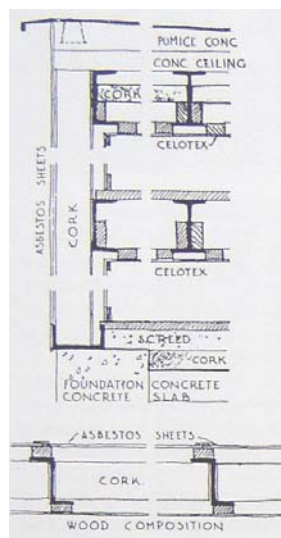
Sección de fachada de la casa de la Weissenhof, Walter Gropius. (Tectonica 1, Envolverte(I), fachadas ligeras, pag.7)
